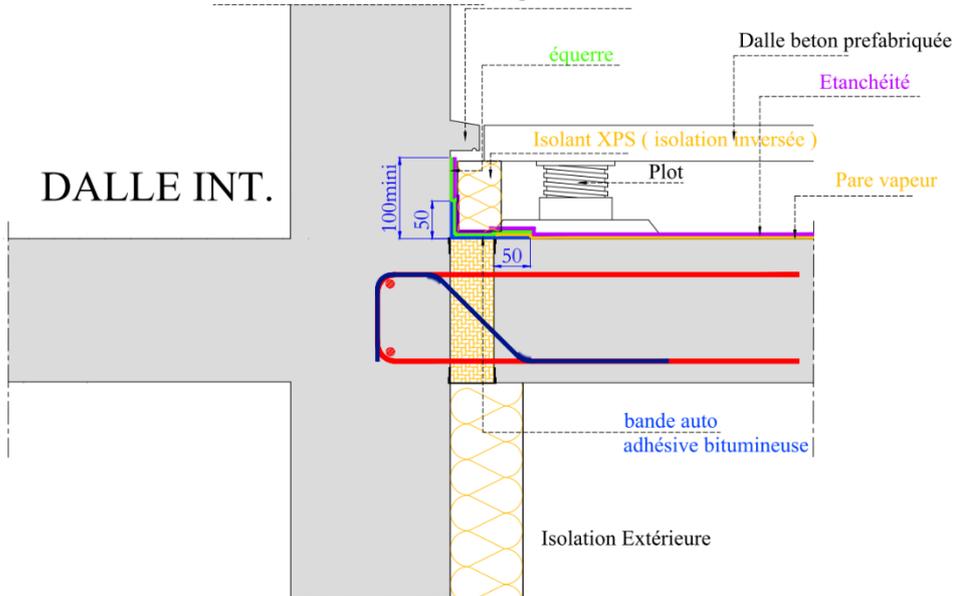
Modèle VE ou VEP, dalle sur plots avec isolation sous dalle sur plot
